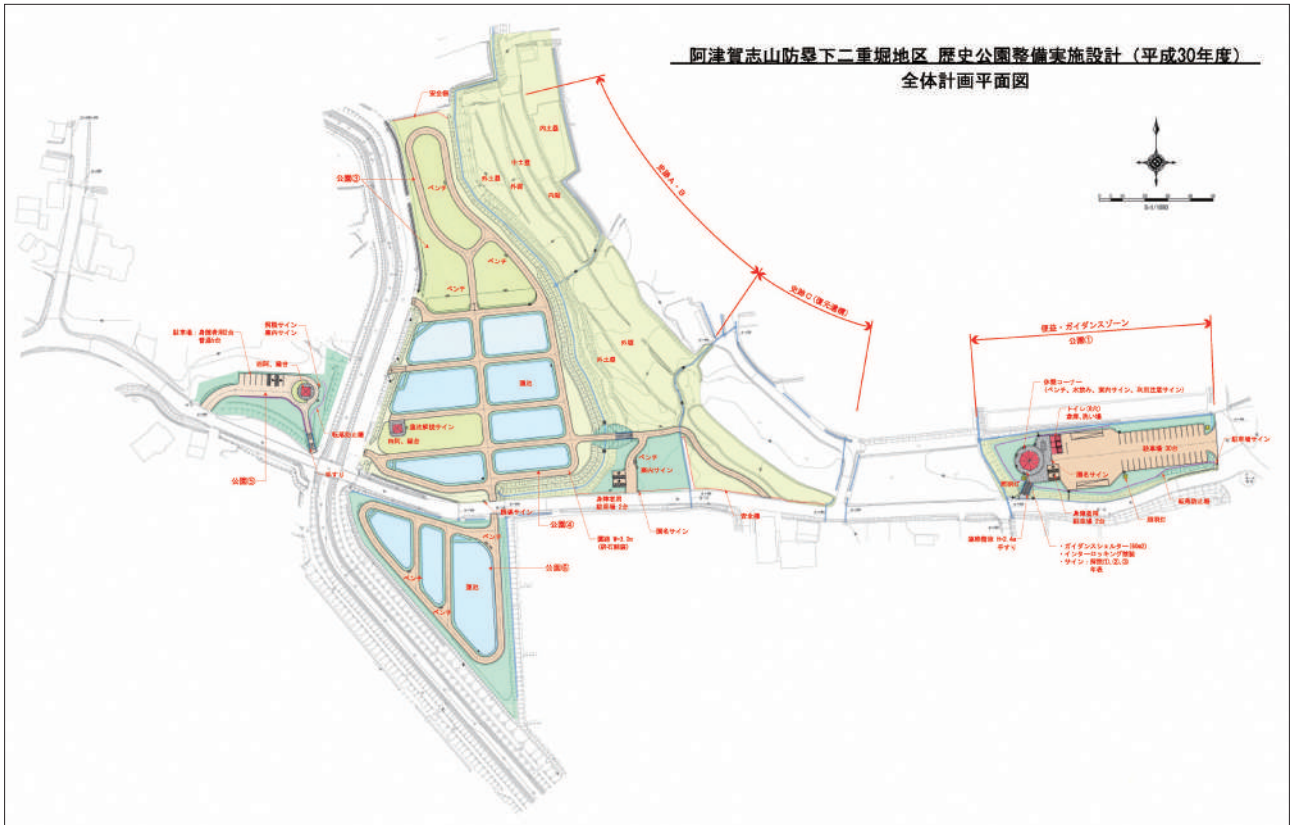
阿津賀志山防皇下二重地区歴史公園整備 全体計画平面図
